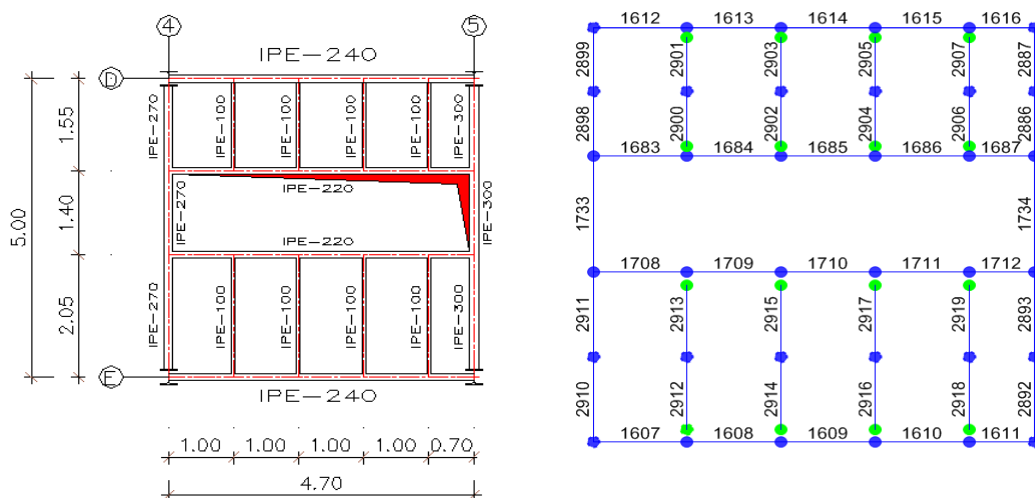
Planta com a Geometria e Identificação das Vigas Internas do Piso 1 dos Alinhamentos 4 e 5.
